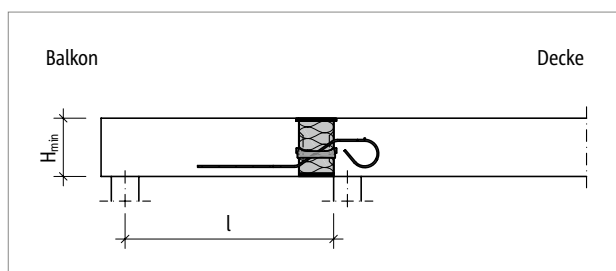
Schöck Isokorb® XT Typ QL: Statisches System (XT Typ QL-V1 bis V4)
